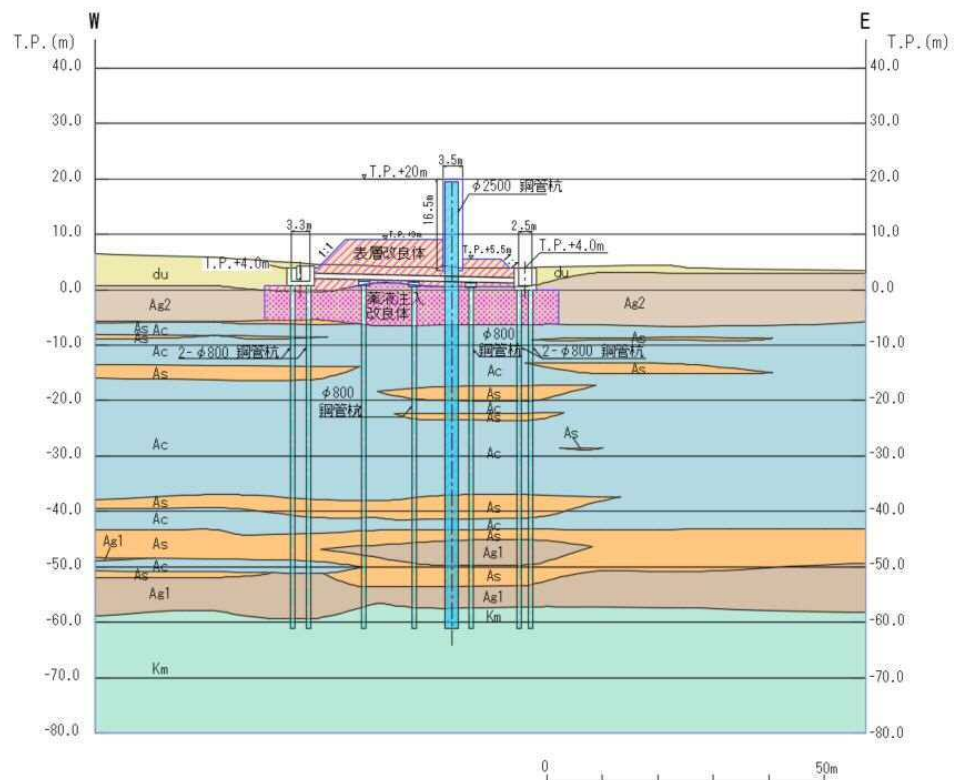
評価対象断面図（排水系統Ⅰ－Ⅱ）
